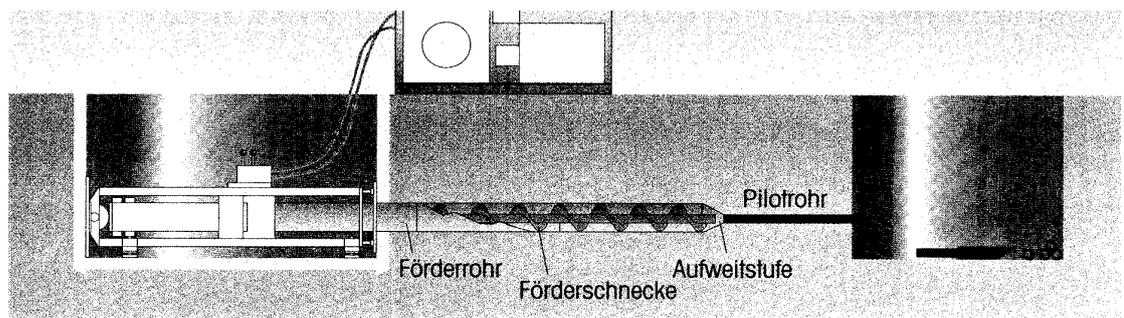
Aufweitstufe mit Förderschnecke am Pilotrohr geführt pressen [2]
